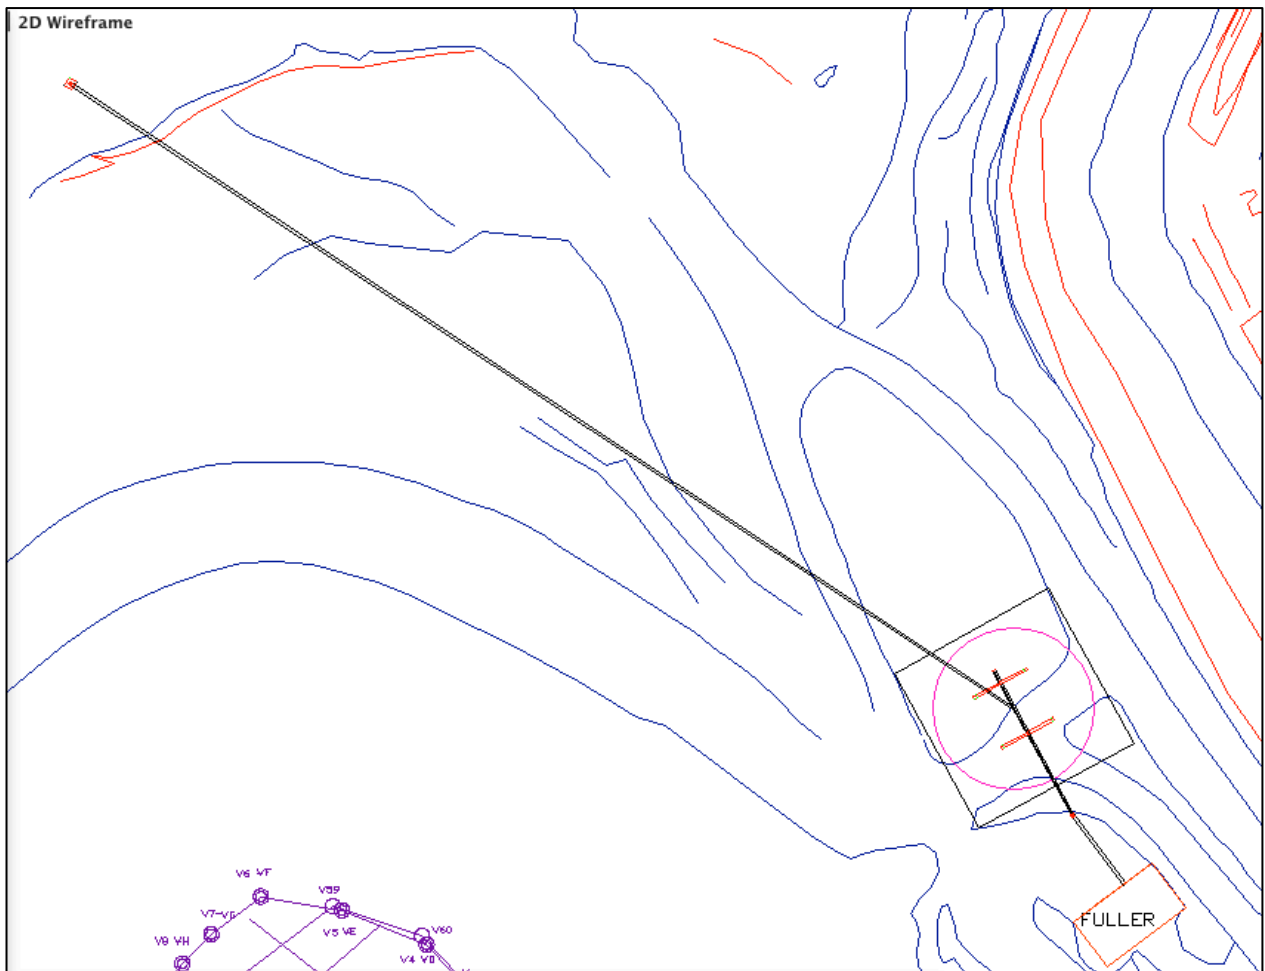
Vista en planta sistema Correa-Stockpile-Correa.
